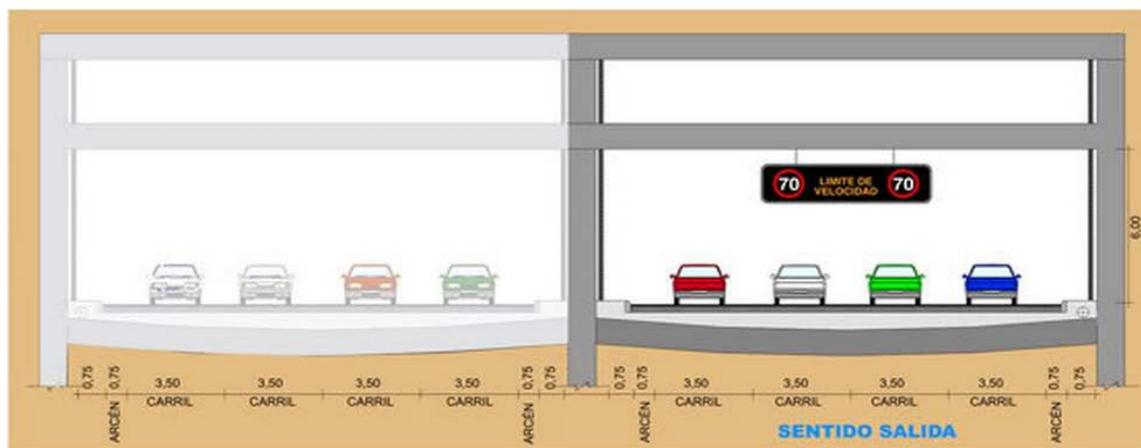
Túnel Avenida de Portugal. Sección transversal bajo la zona ajardinada. 4 carriles
